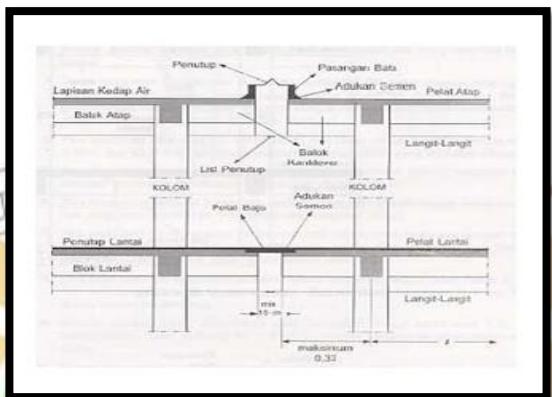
Dilatasi pada Bangunan Asimetris
